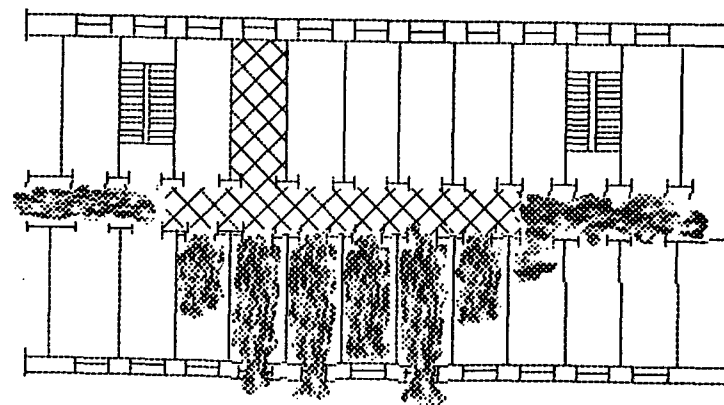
Схема распространения пожара в этаже с коридорной планировкой.
